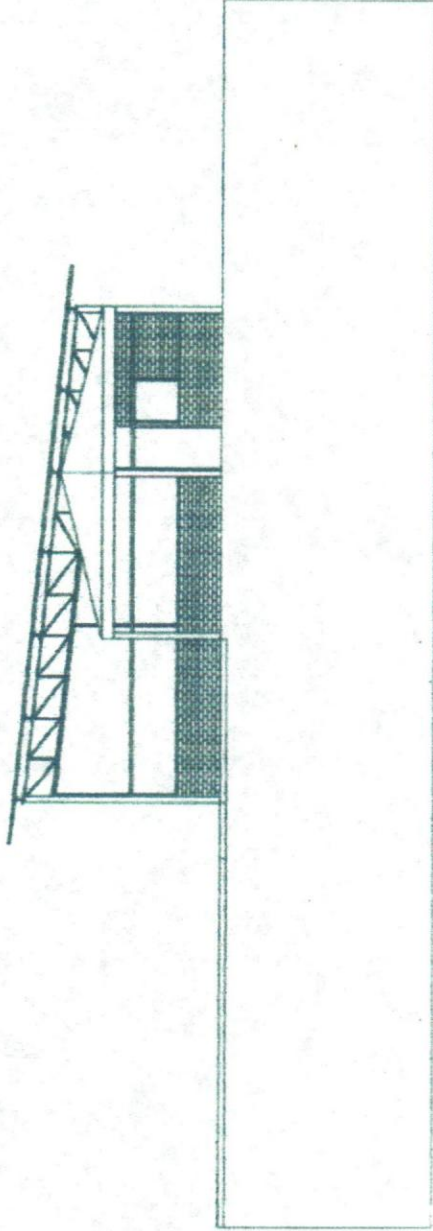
Vivero U.C.A.B.;* plano de estructura – fachada lateral Oeste
